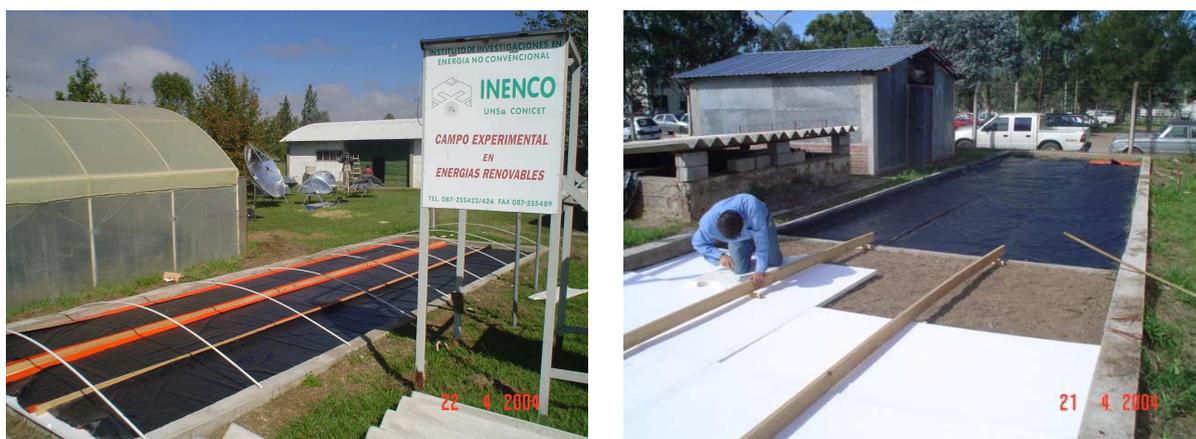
a) Foto de la estructura de caño flexible para la cubierta. b) Foto del depósito, laboratorio y colector en construcción.
